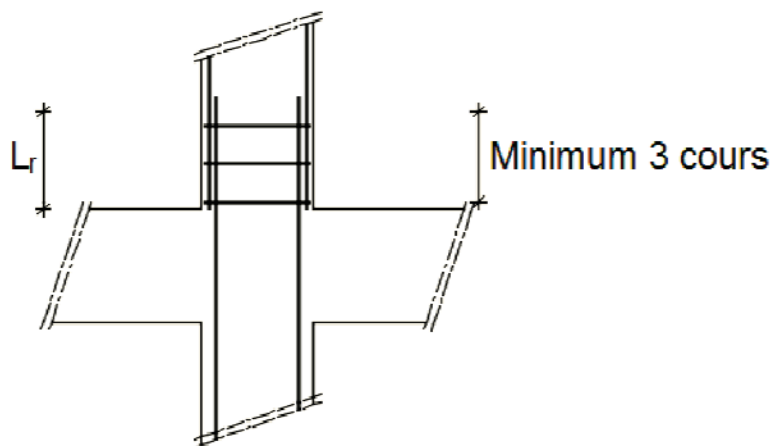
Armatures transversales dans la zone de recouvrement.
